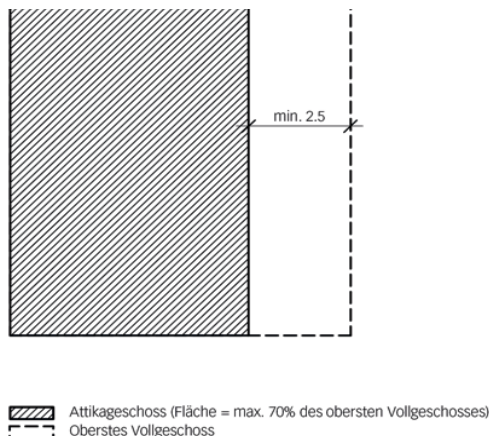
Das Attikageschoss soll auf einer Seite um mindestens 2.5 m zurückversetzt werden.
